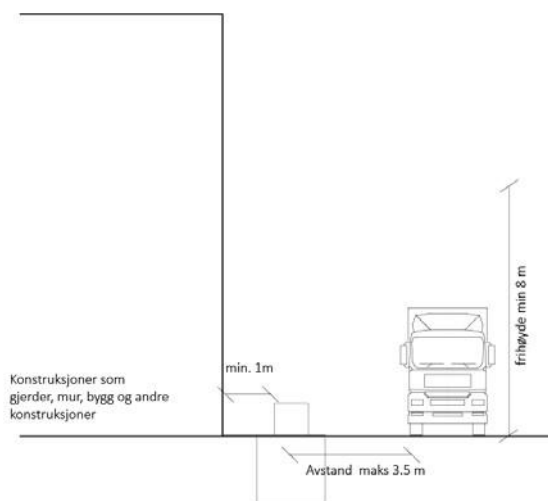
ILLUSTRASJON AV PlassERING I PLAN
